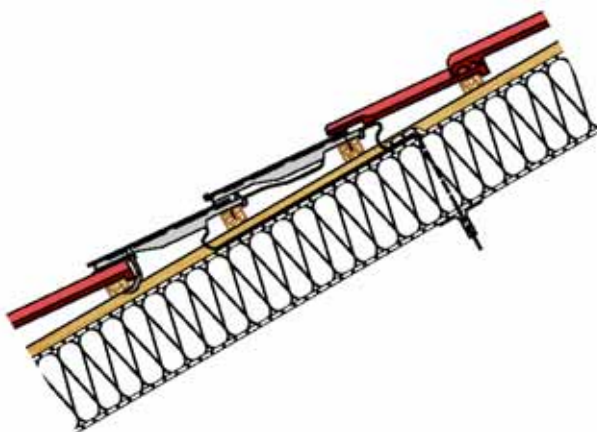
Secção de corte longitudinal com abertura de telhado correctamente executada
